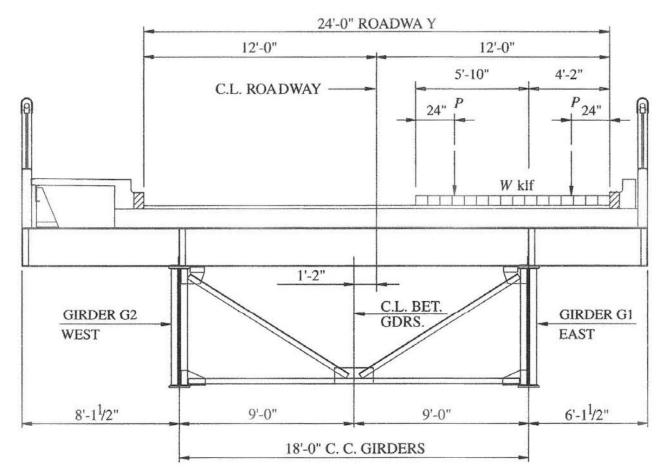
Posición crítica para producir el momento negativo máximo en la viga del piso
